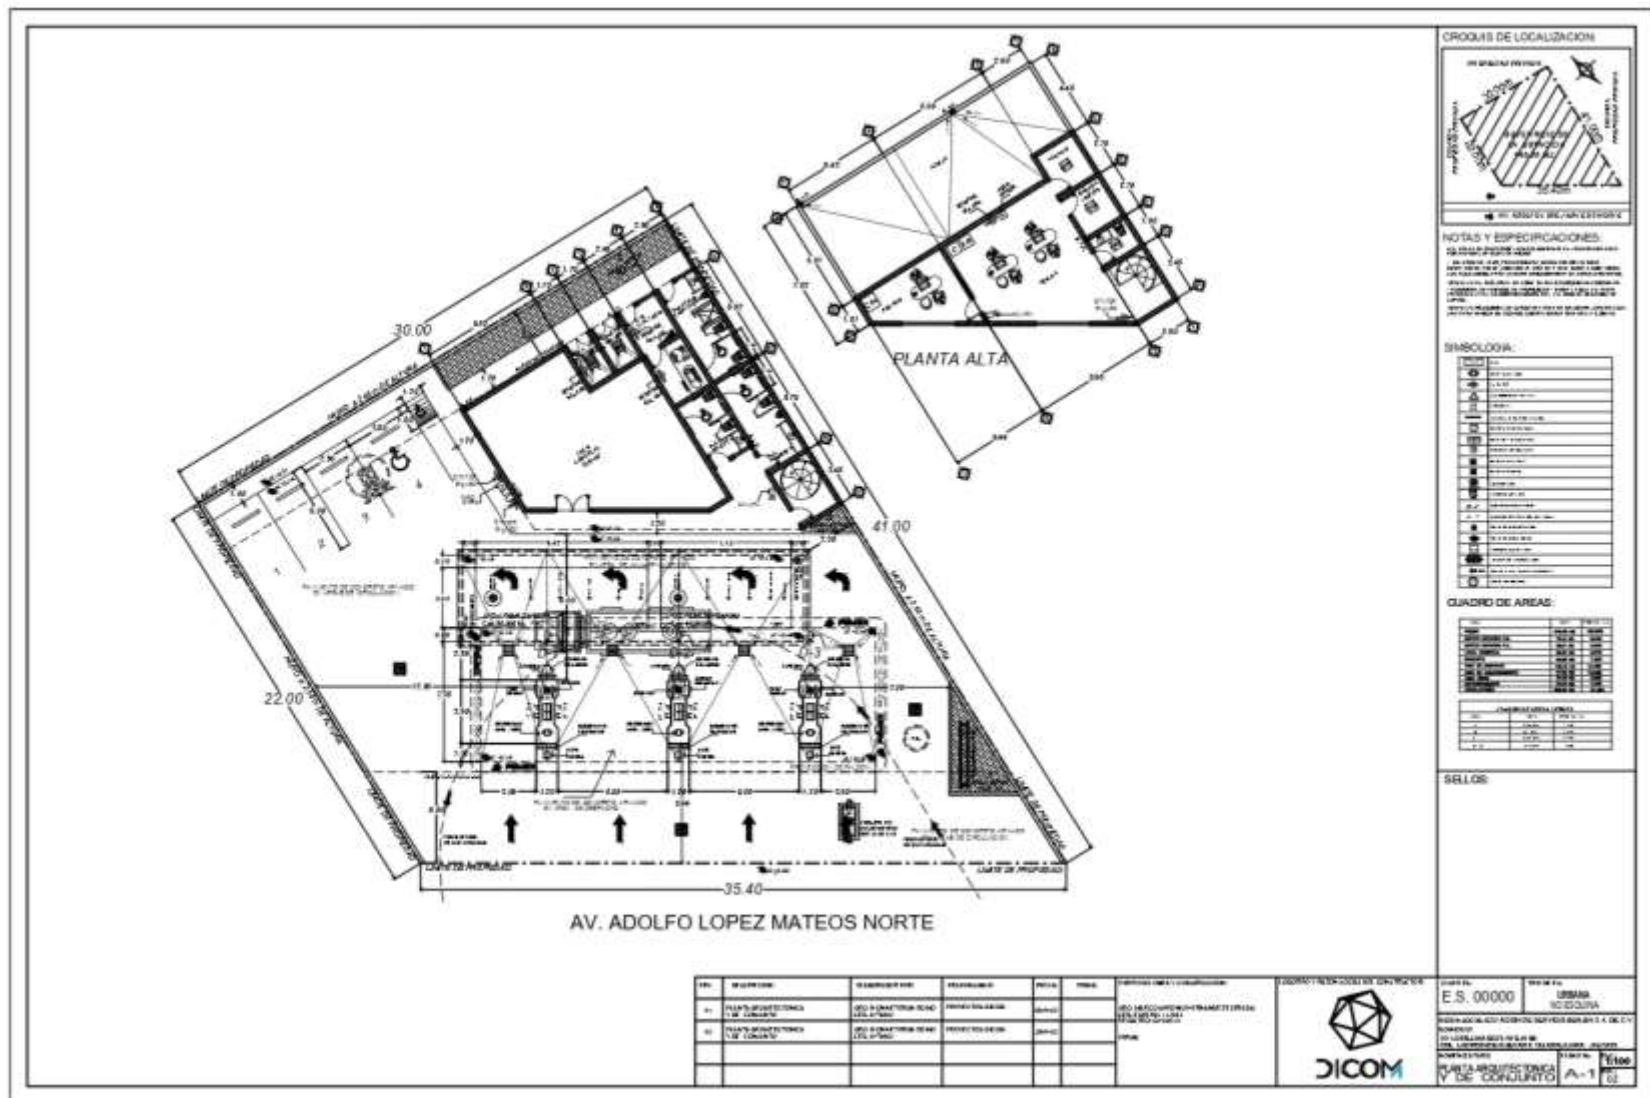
Imagen del plano A-1 planta arquitectónica y de conjunto proyectado.
